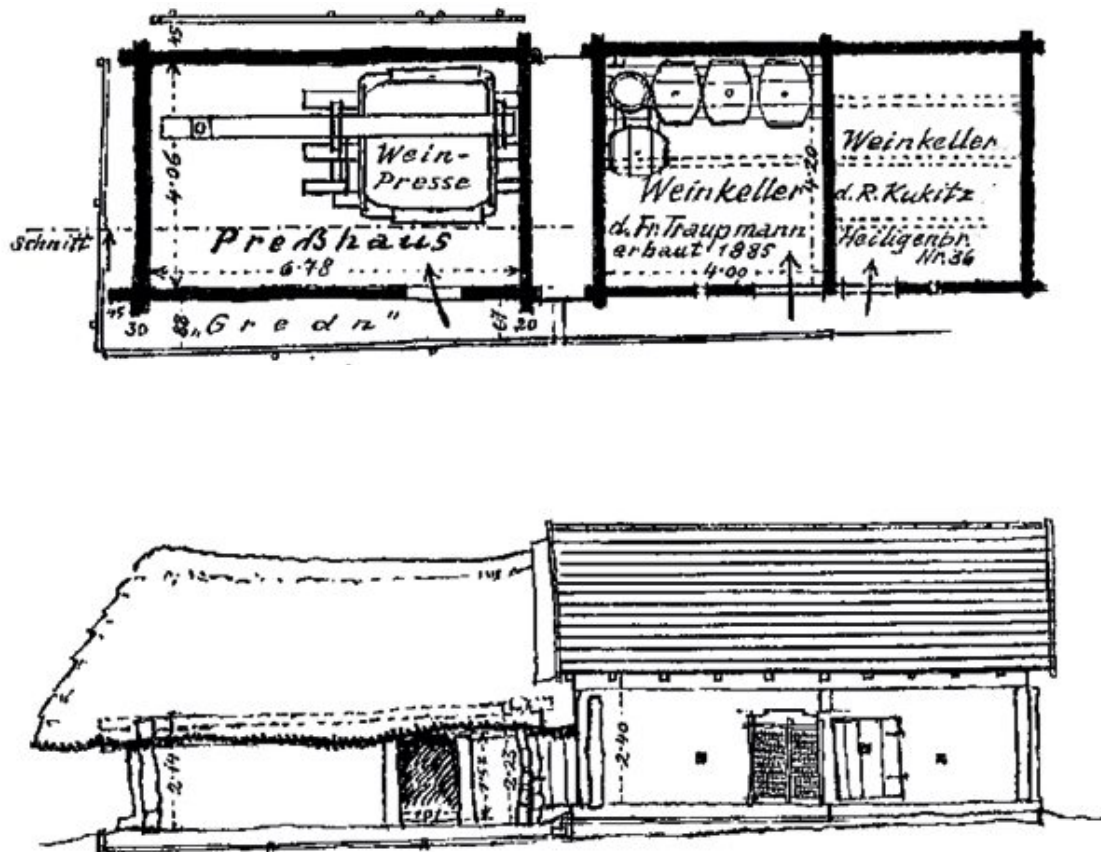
| Presshaus aus Heiligenbrunn: Grundriss und Ansicht der Eingangsseite (Franz Simon 1974)
